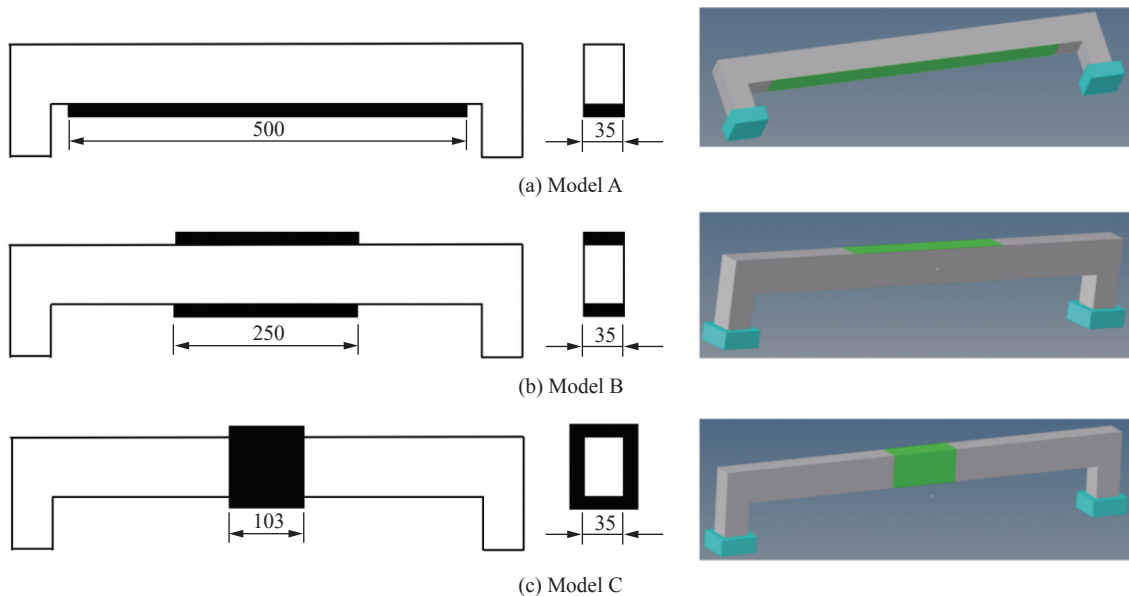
3 种涂覆位置 RC 梁有限元模型(单位: mm)
